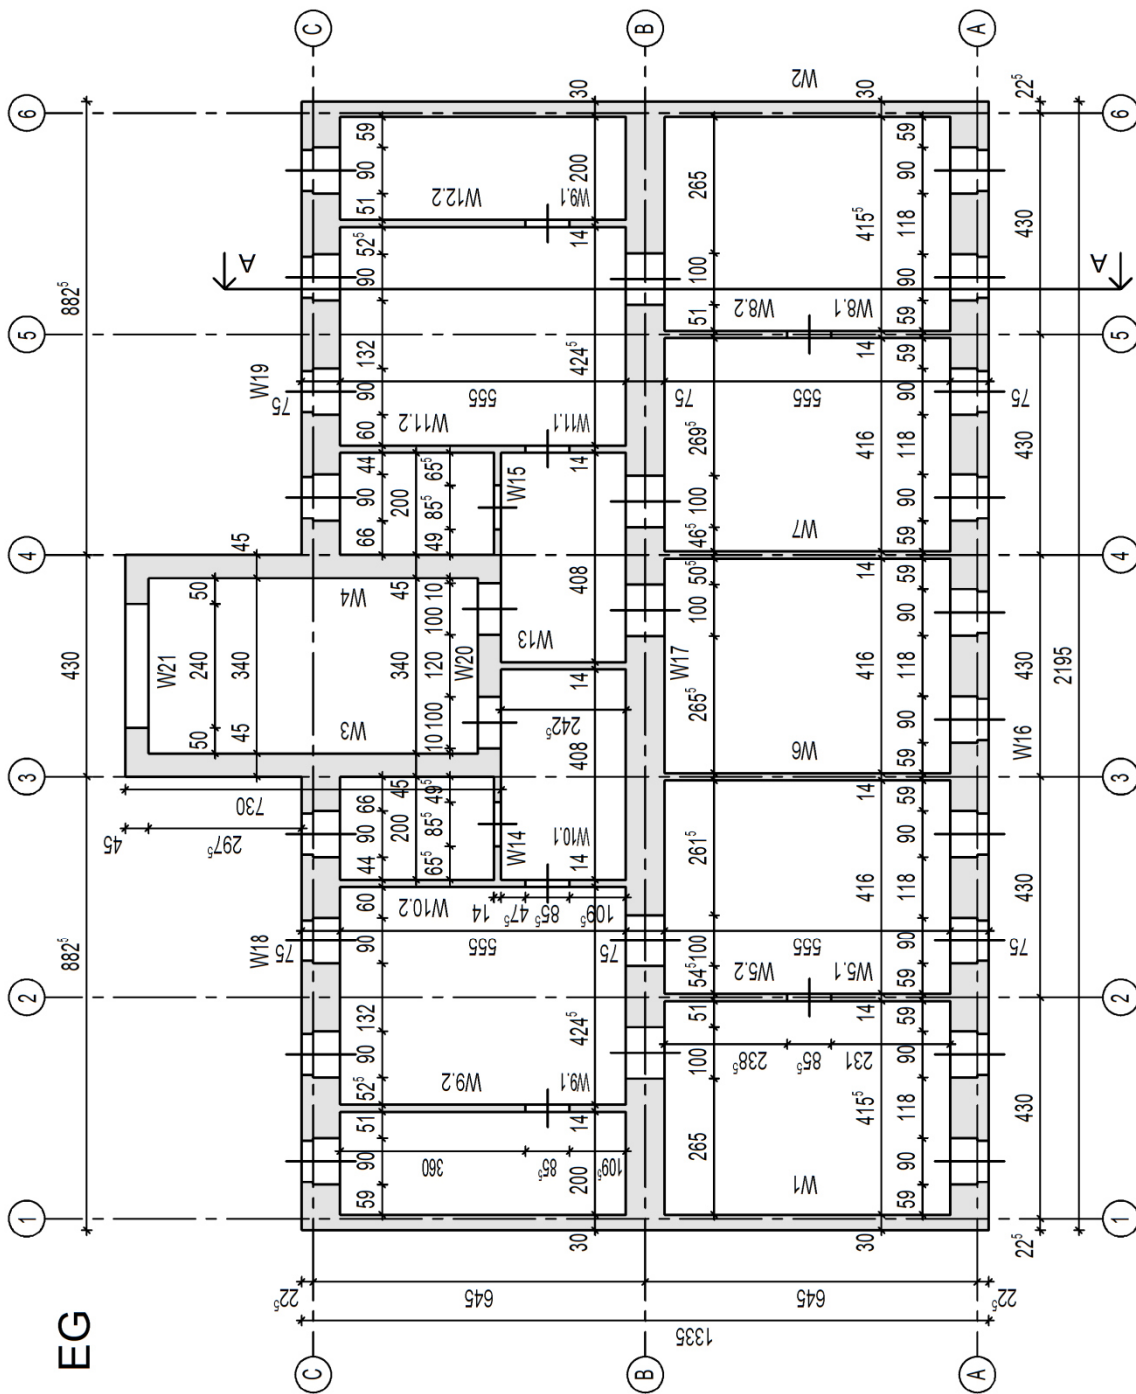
Beispielsberechnung: Grundriss Erdgeschoß des typischen Gründerzeithauses
